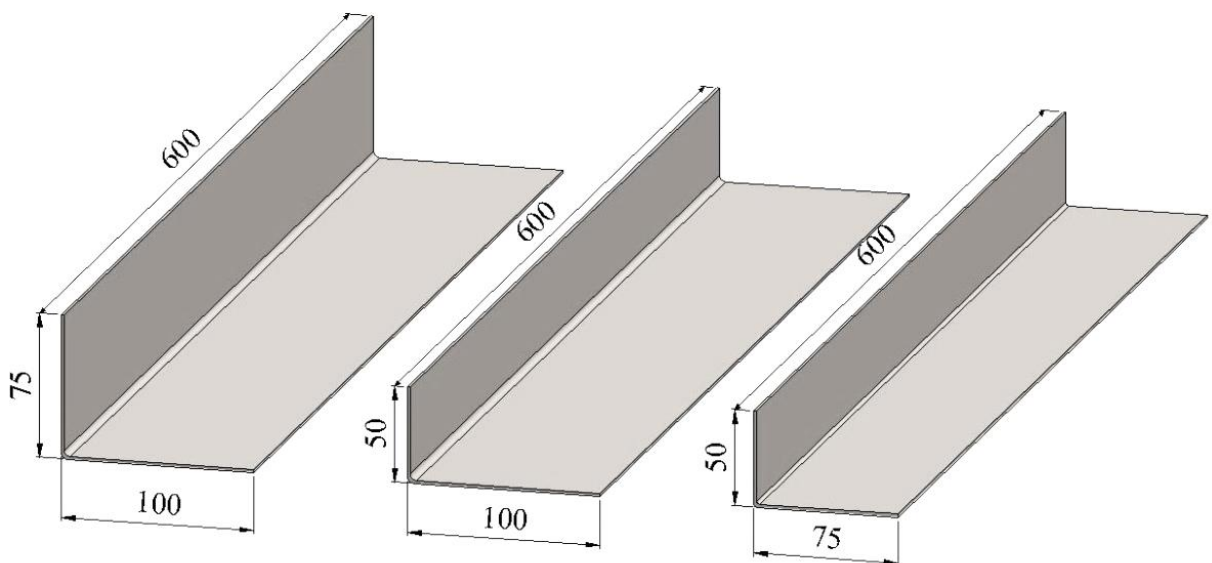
Dimensões em (mm) das seções transversais das cantoneiras de abas desiguais
